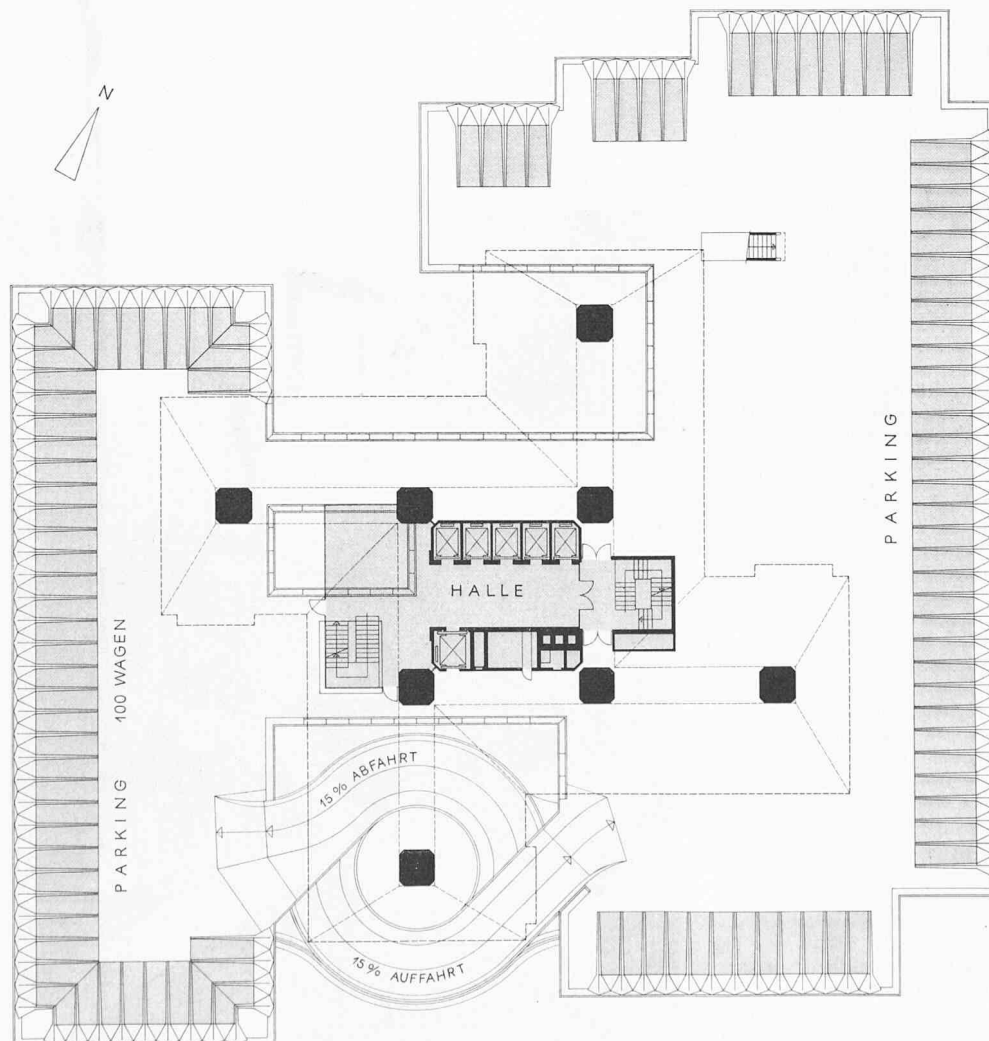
Zweites Obergeschoss 1:500 mit Autorampe und «Parking»
